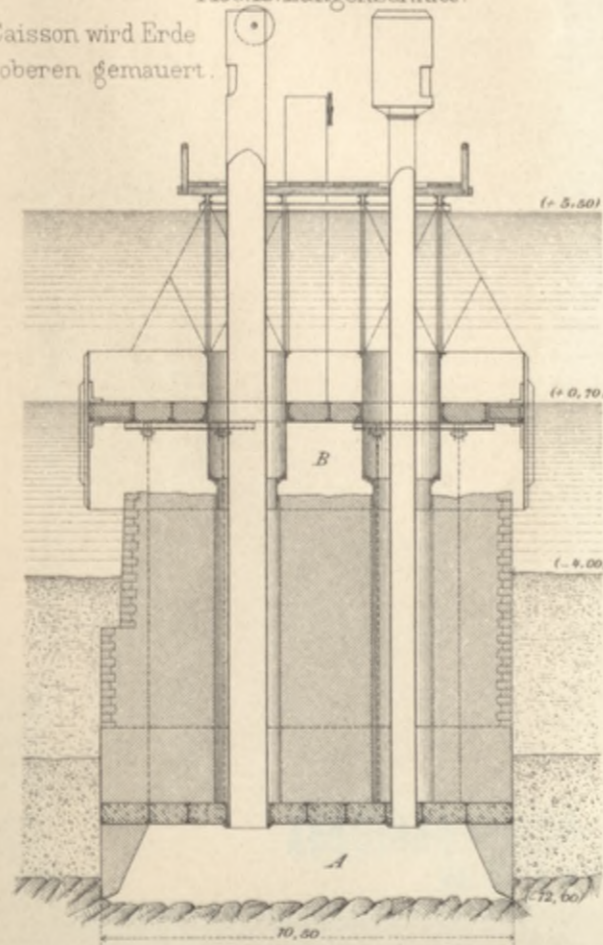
M. 1:400. Querschnitt durch den Caisson während seiner Versenkung.
